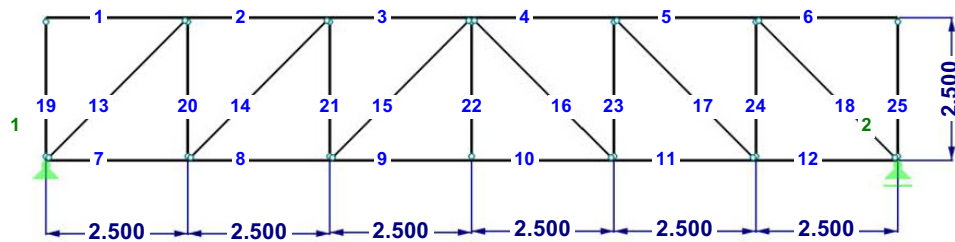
Statisches System des betrachteten Fachwerkes
